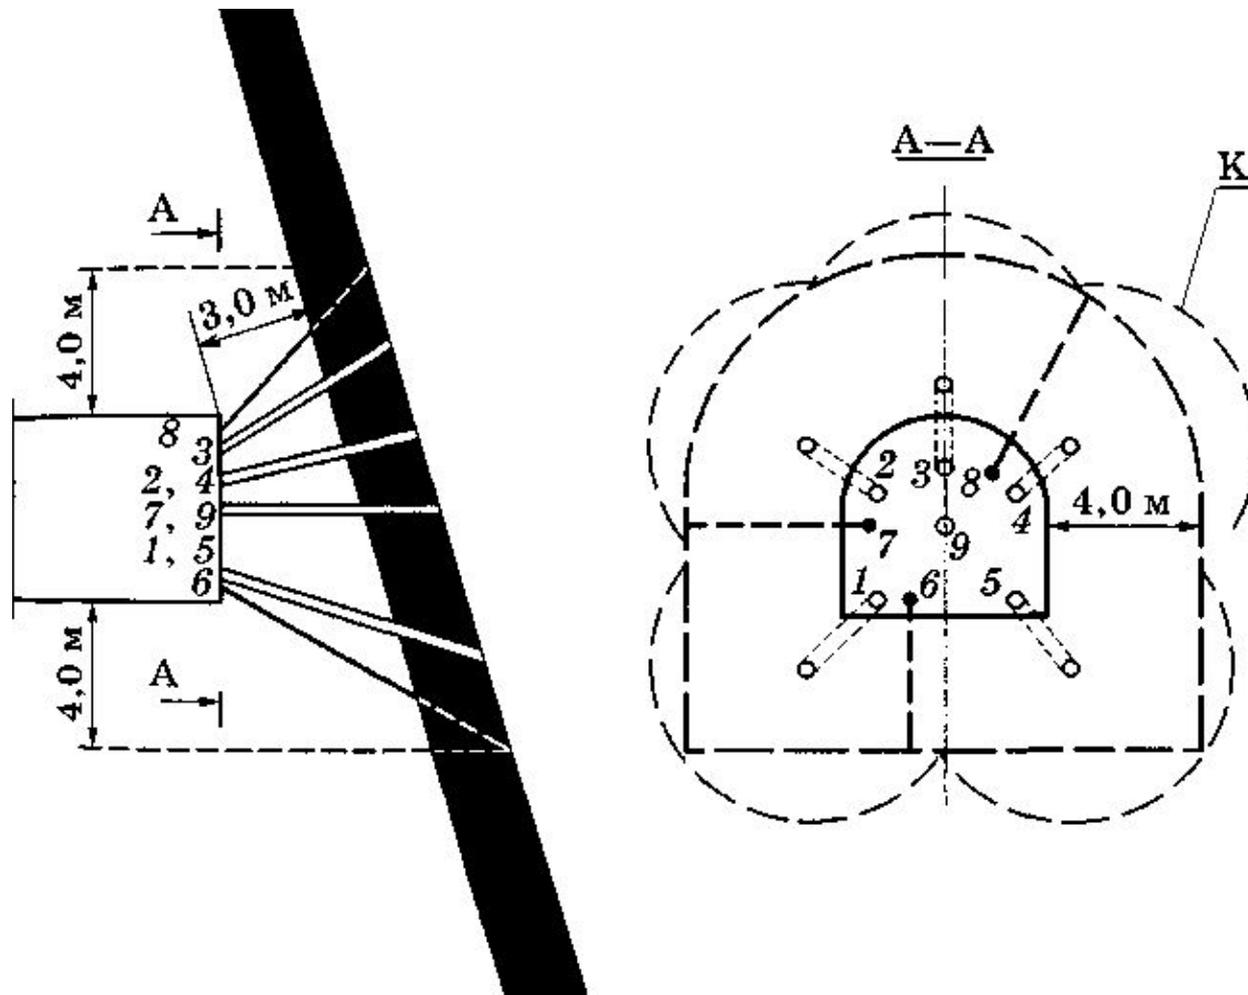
Схема расположения скважин для гидрообработки угольного массива перед вскрытием крутого пласта:
